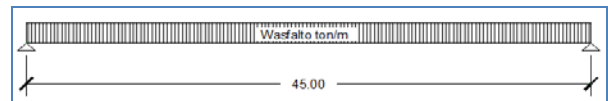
Etapa 4. Viga compuesta a cargas de largo plazo de asfalto
